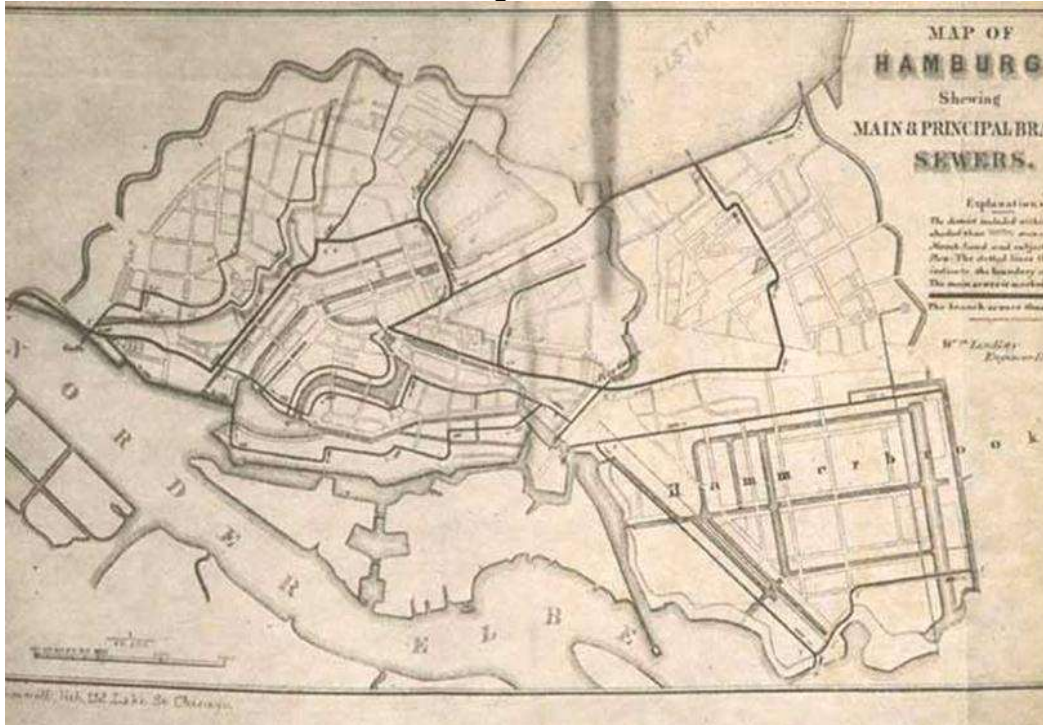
Primeras conducciones de alcantarillado de aguas residuales - 1887
